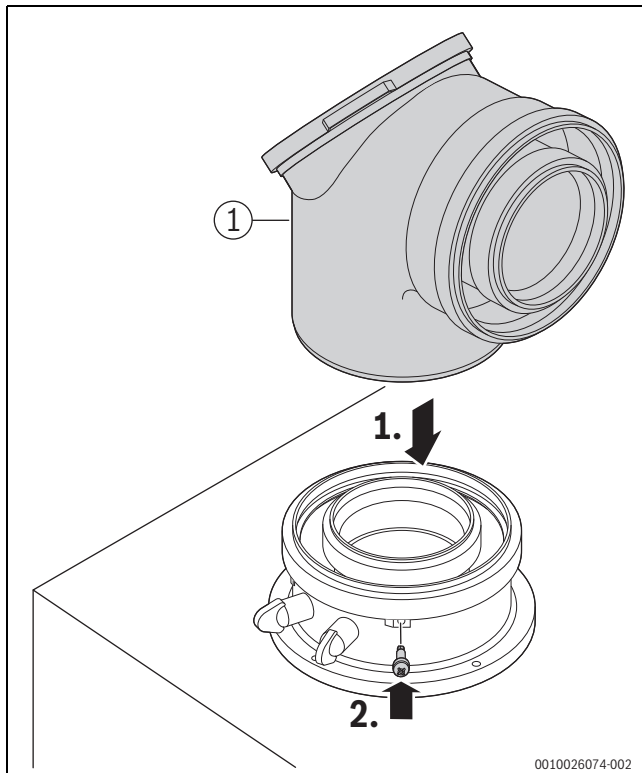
Abgaszubehör einsetzen und mit Schraube sichern
